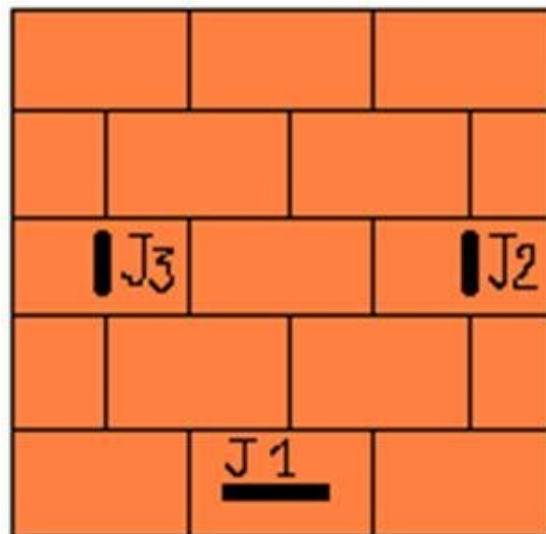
Emplacement des jauges pour l'essai n°2
